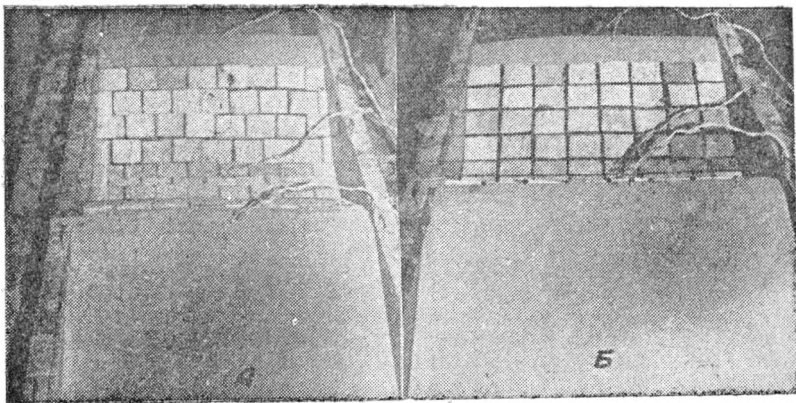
Устройство бетонной облицовки сборной конструкции в модели канала в насыпи. А — укладка плит по шахматной схеме; Б — по рядовой схеме.
